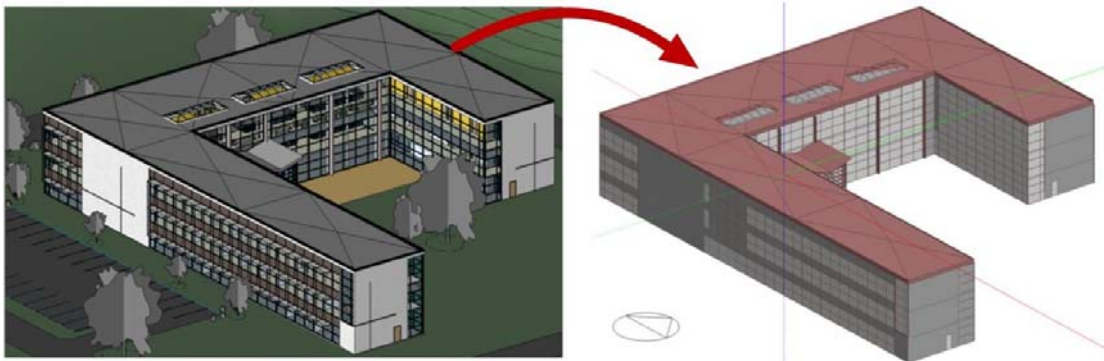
Exemplo de conversão de Revit para DesignBuilder (Fonte: DesignBuilder (2013))
